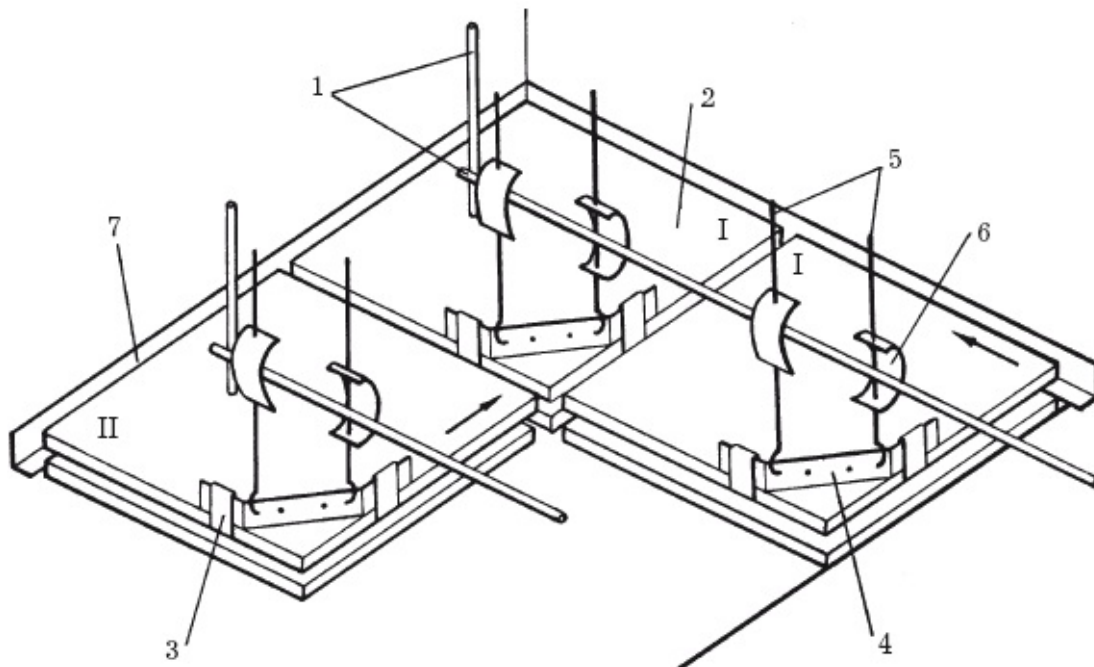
Устройство плиточного потолка с использованием чернового каркаса: 1 – элементы чернового каркаса; 2 – облицовочные плитки; 3 – закладные крюки; 4 – крепежная скоба; 5 – вертикальная подвеска; 6 – согнутая (пружинная) пластина; 7 – пристенный опорный уголок
